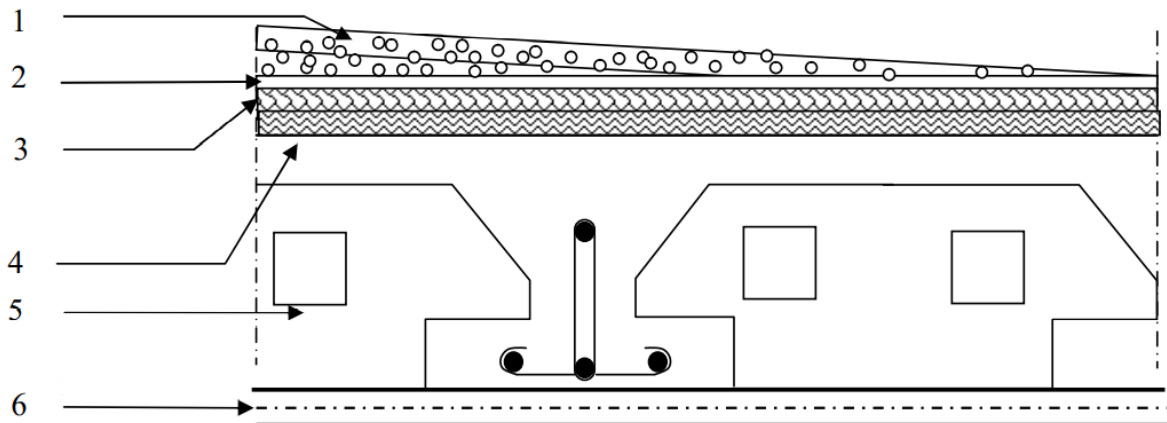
Schéma de plancher à corps creux terrasse inaccessible
